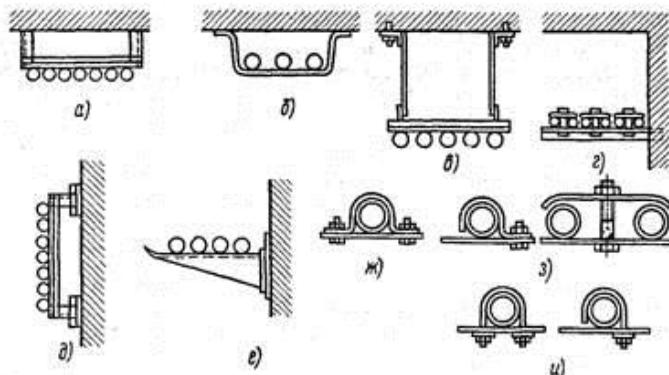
Способы крепления труб к опорным конструкциям: а – в – потолочных опорных конструкций из уголка, перфорированной полосы и на подвесках; г – е – настенных опорных конструкций и кронштейнов; ж – и – хомутов, полухомутов и двух однолапковых скоб и накладок
